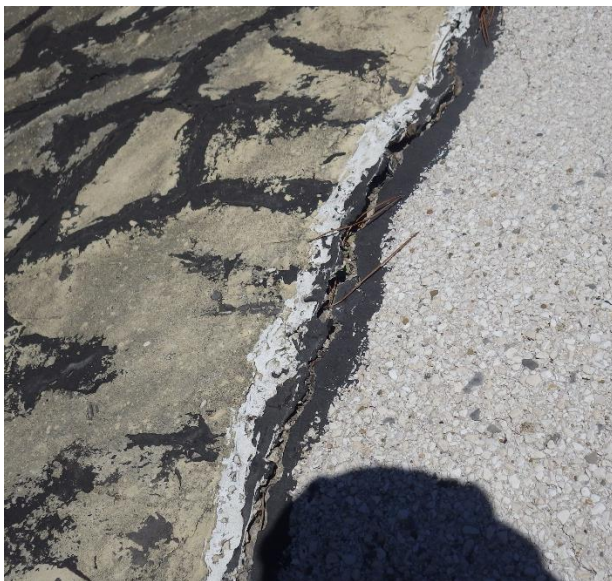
Défaut n°4 – Décollement au niveau de la doucine
